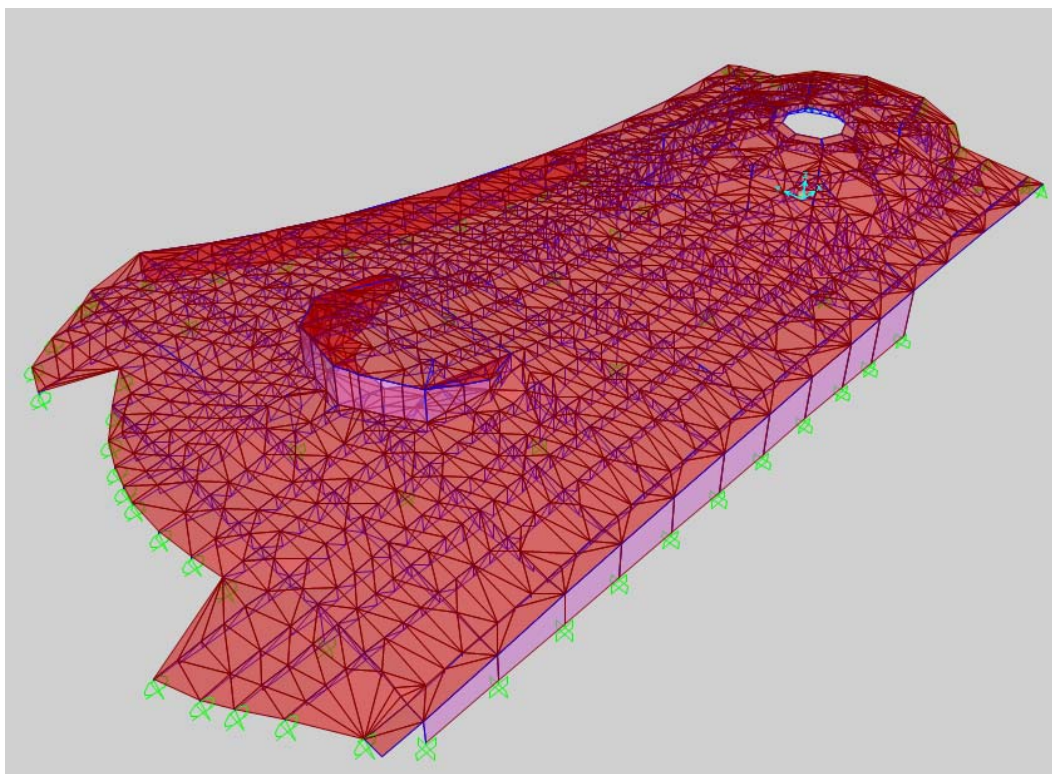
Vista 3D del modelo de cálculo de la cubierta con elementos shell.
